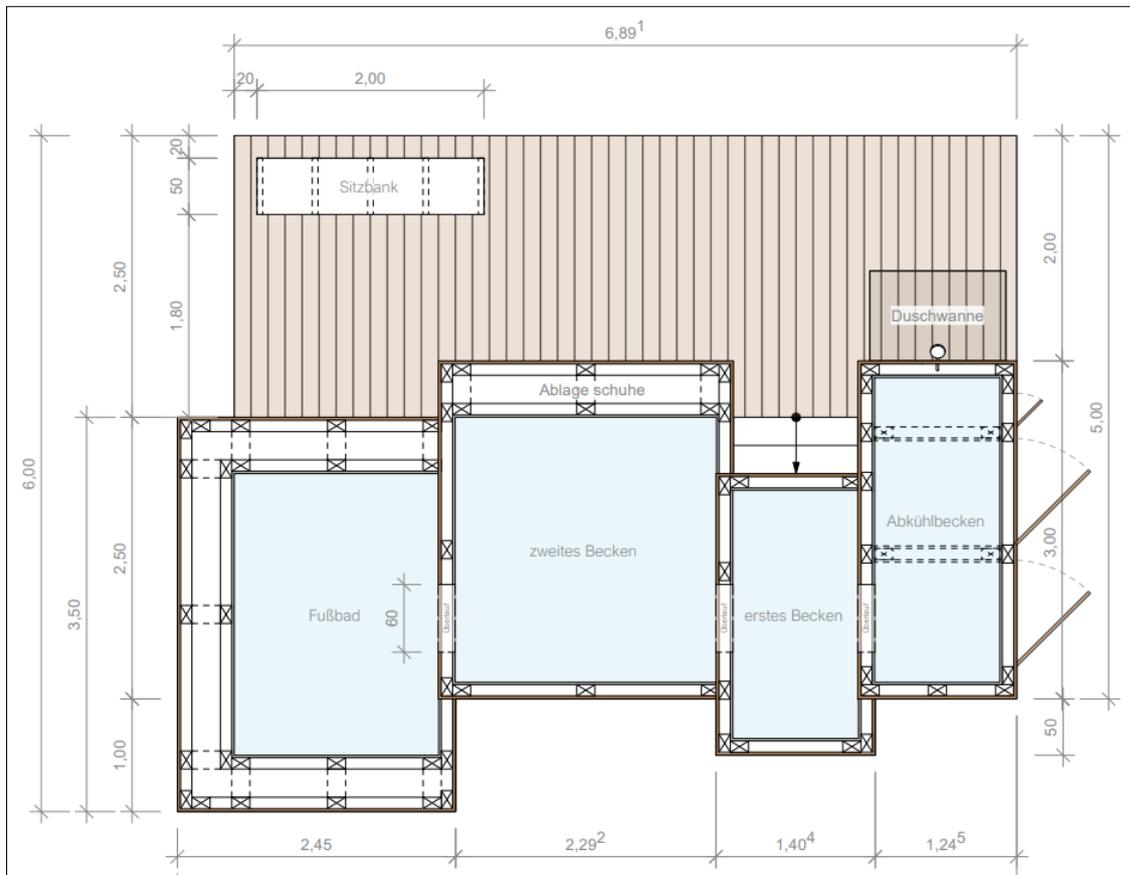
Grundriss der Anlage (FH Aachen, Fachbereich Architektur)
